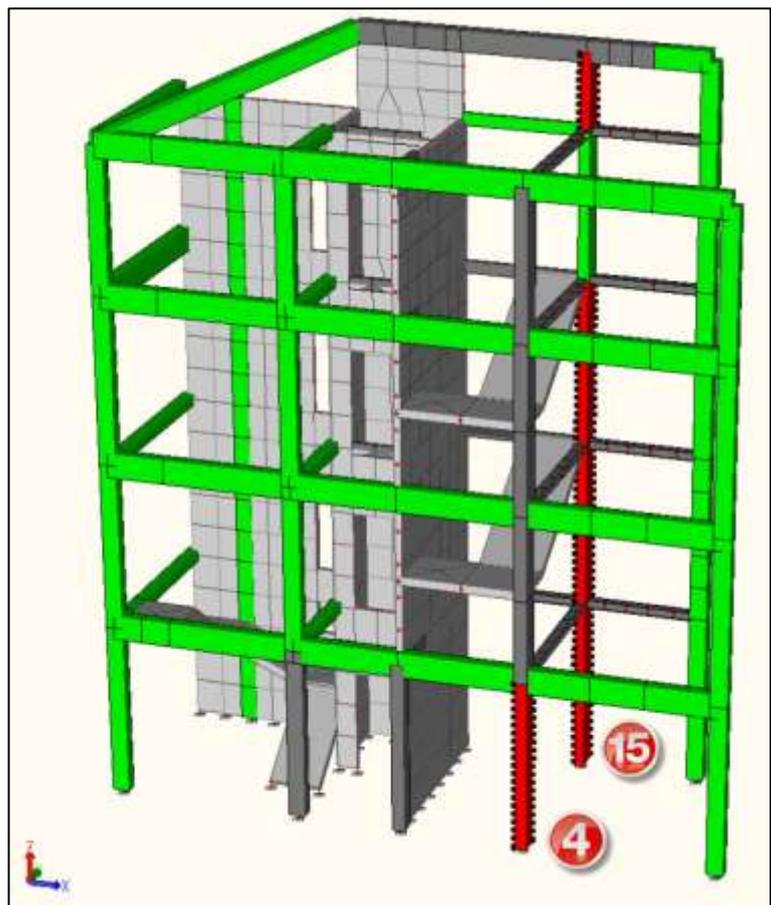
interventi posti in opera. Indicazione dei pilastri.
